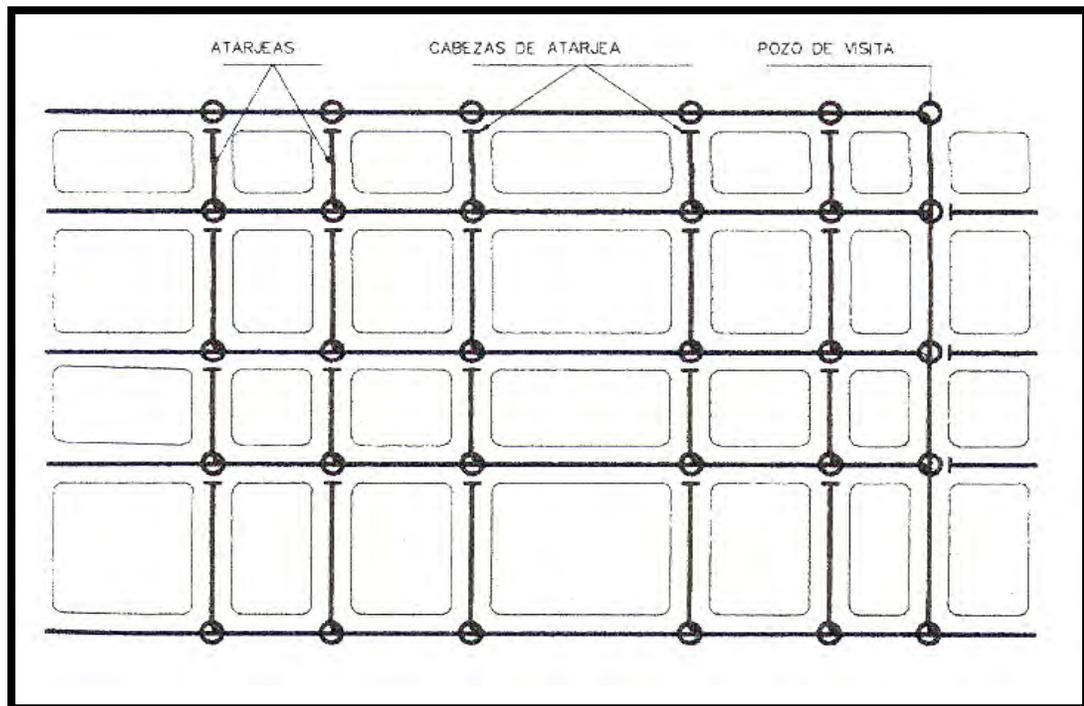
Trazo en peine para el sistema de alcantarillado, (Ref.1)
